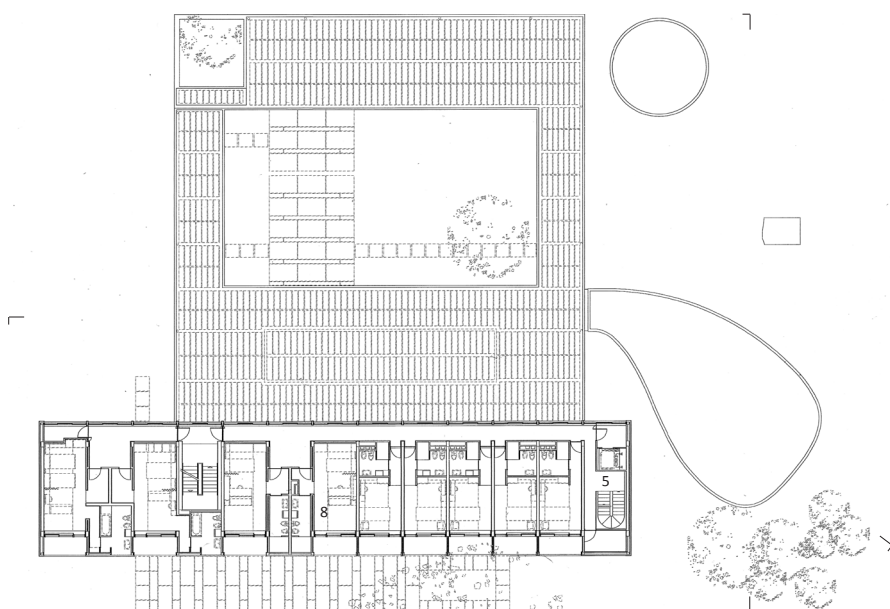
Planta Piso 1 e 2 - Segunda proposta de intervenção.
